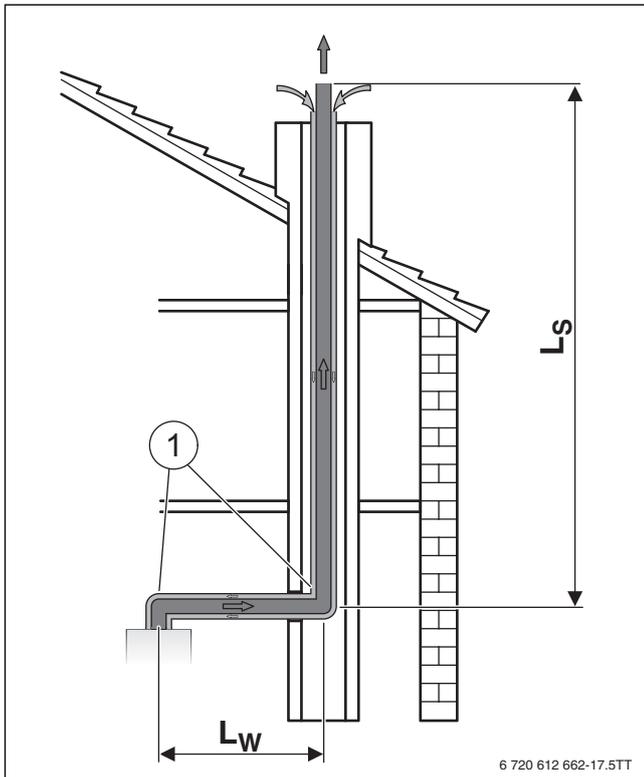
Abgasführung mit konzentrischem Rohr im Schacht nach C_{33x}
